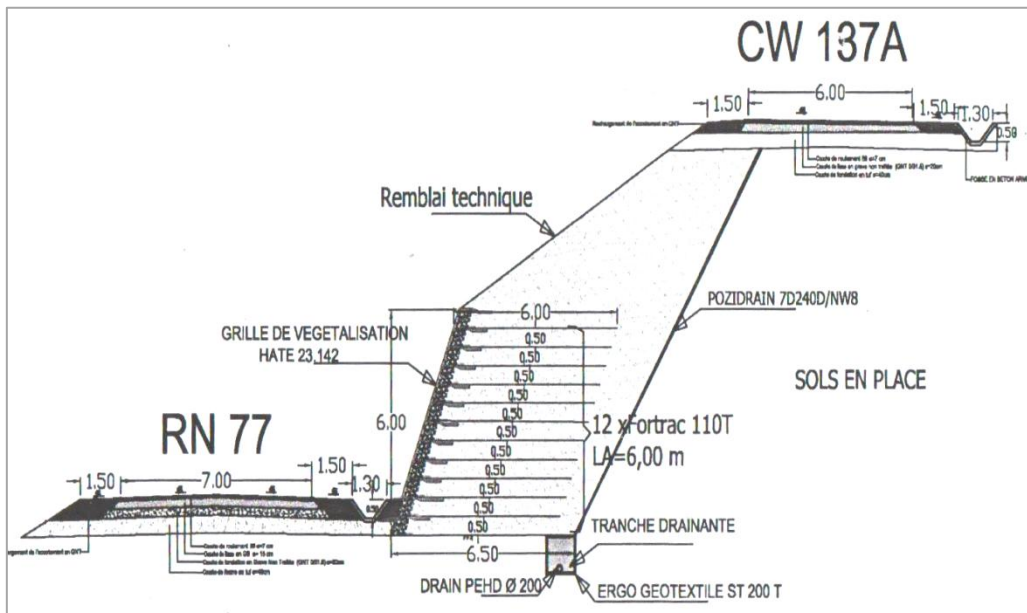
Profil en travers avec dispositif de renforcement par géogrilles.
